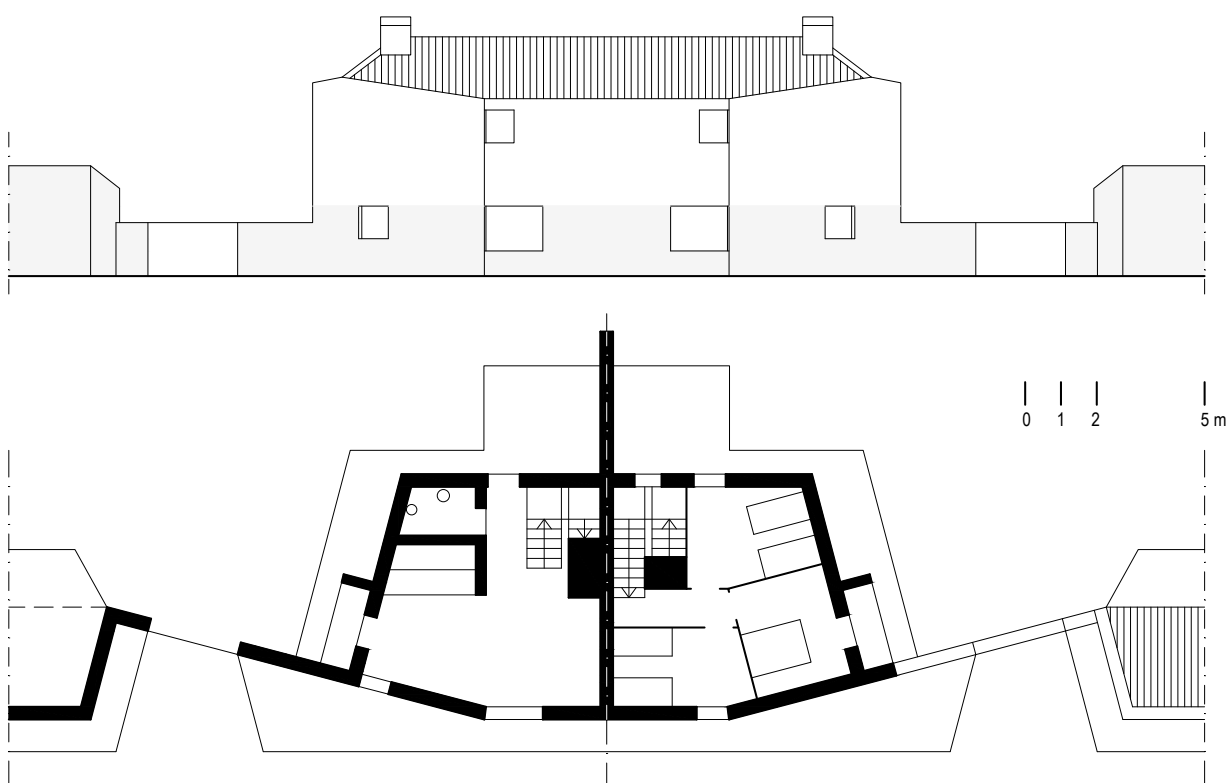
Fernández del Amo, casa del colono (tipo B) a El Realengo. Pianta del piano terra (a sinistra) e del primo piano (a destra), alzato su strada (Ridisegno dell'autore).
